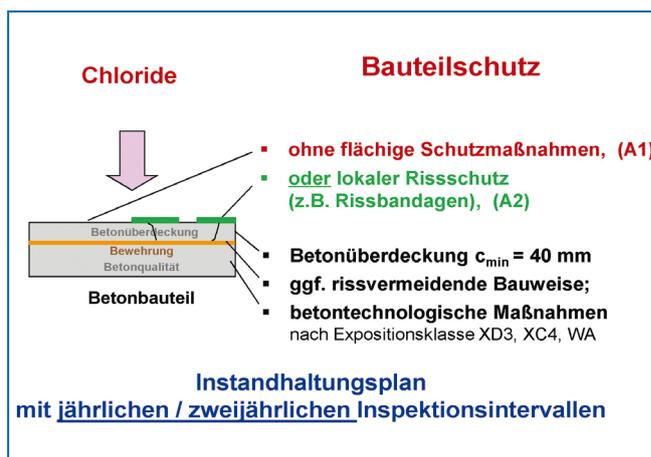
Planungsvariante A: Schutz des Betonbauteils ohne flächige Schutzmaßnahmen jedoch mit besonderen Maßnahmen bei Rissen
